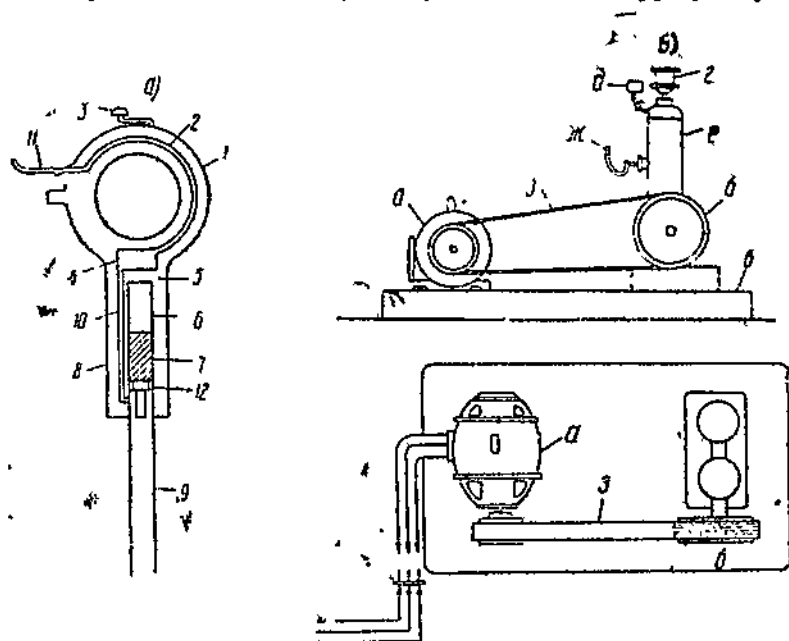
Пневматическая установка для пробивки дыр в стенах:
